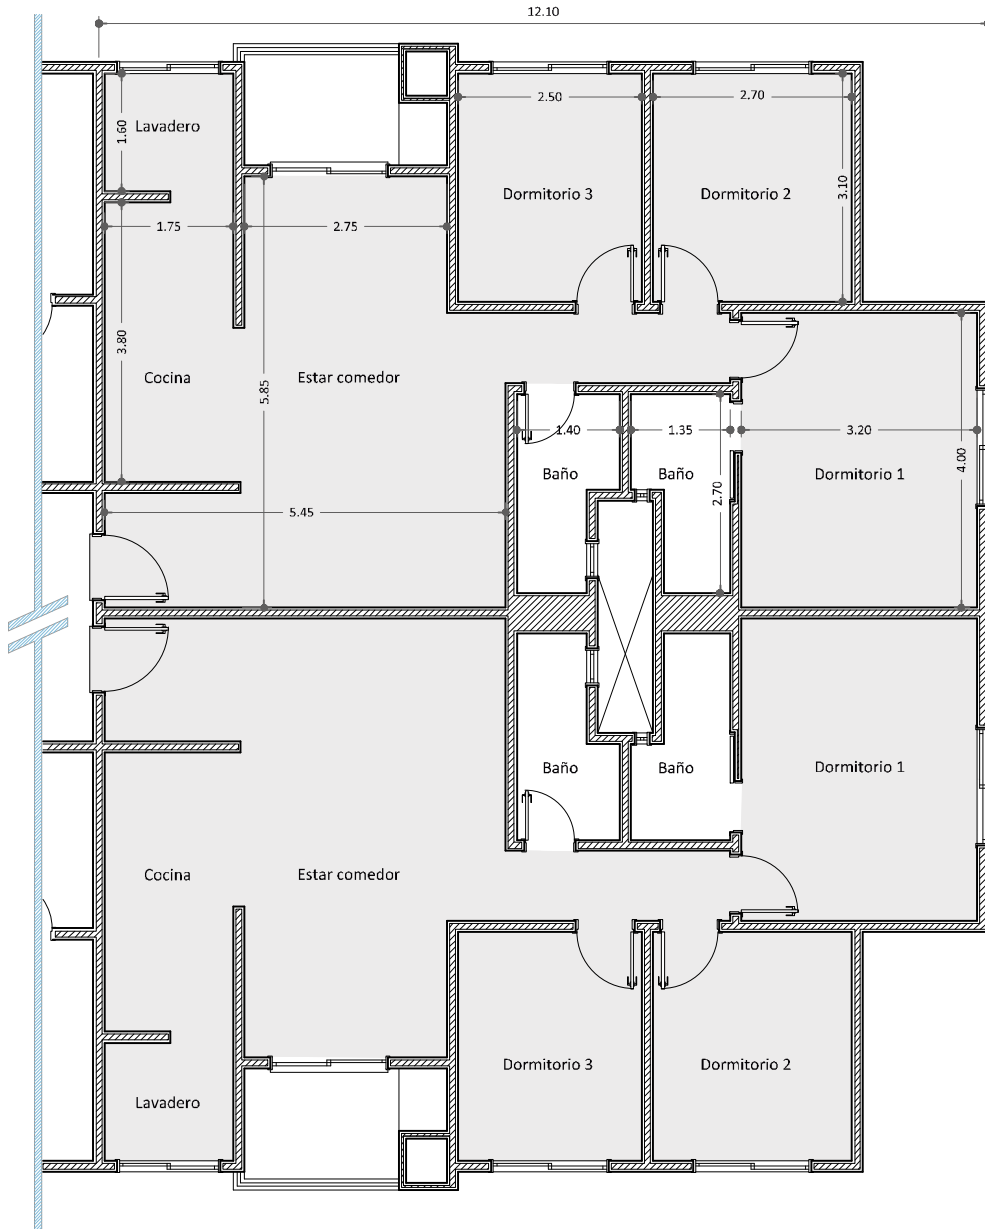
Planta baja del Caso IV: vivienda multifamiliar. Planta tipo en los doce niveles.
